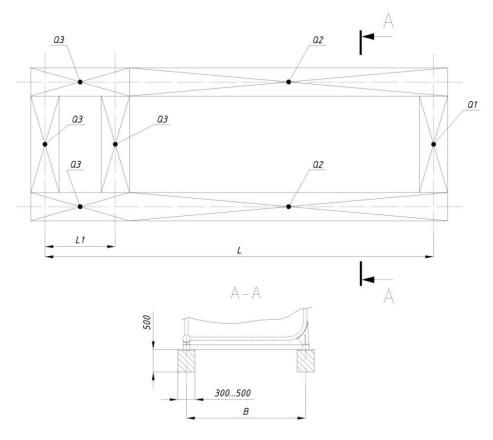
Схематическое изображение нагрузок на фундамент
